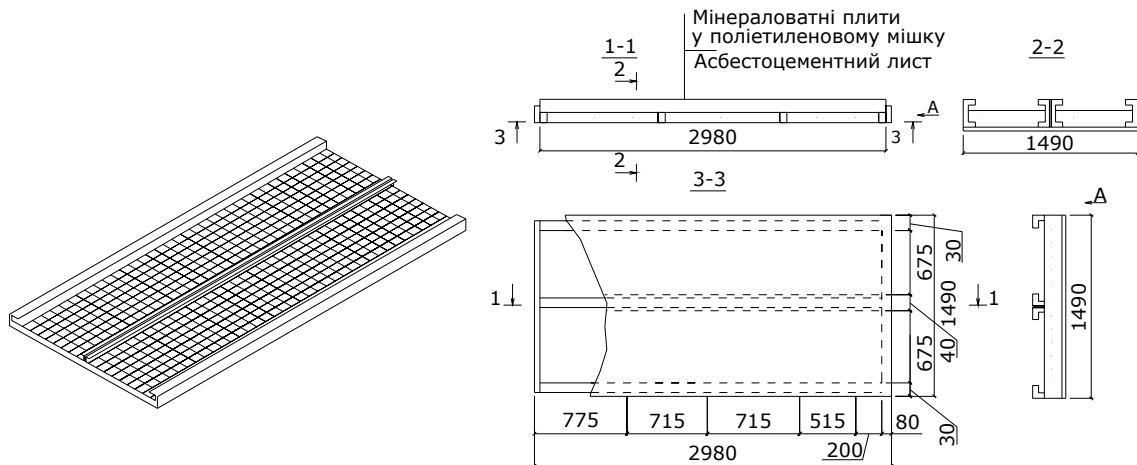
Азбестоцементна плита покриття на каркасі з екструзійних швелерів
